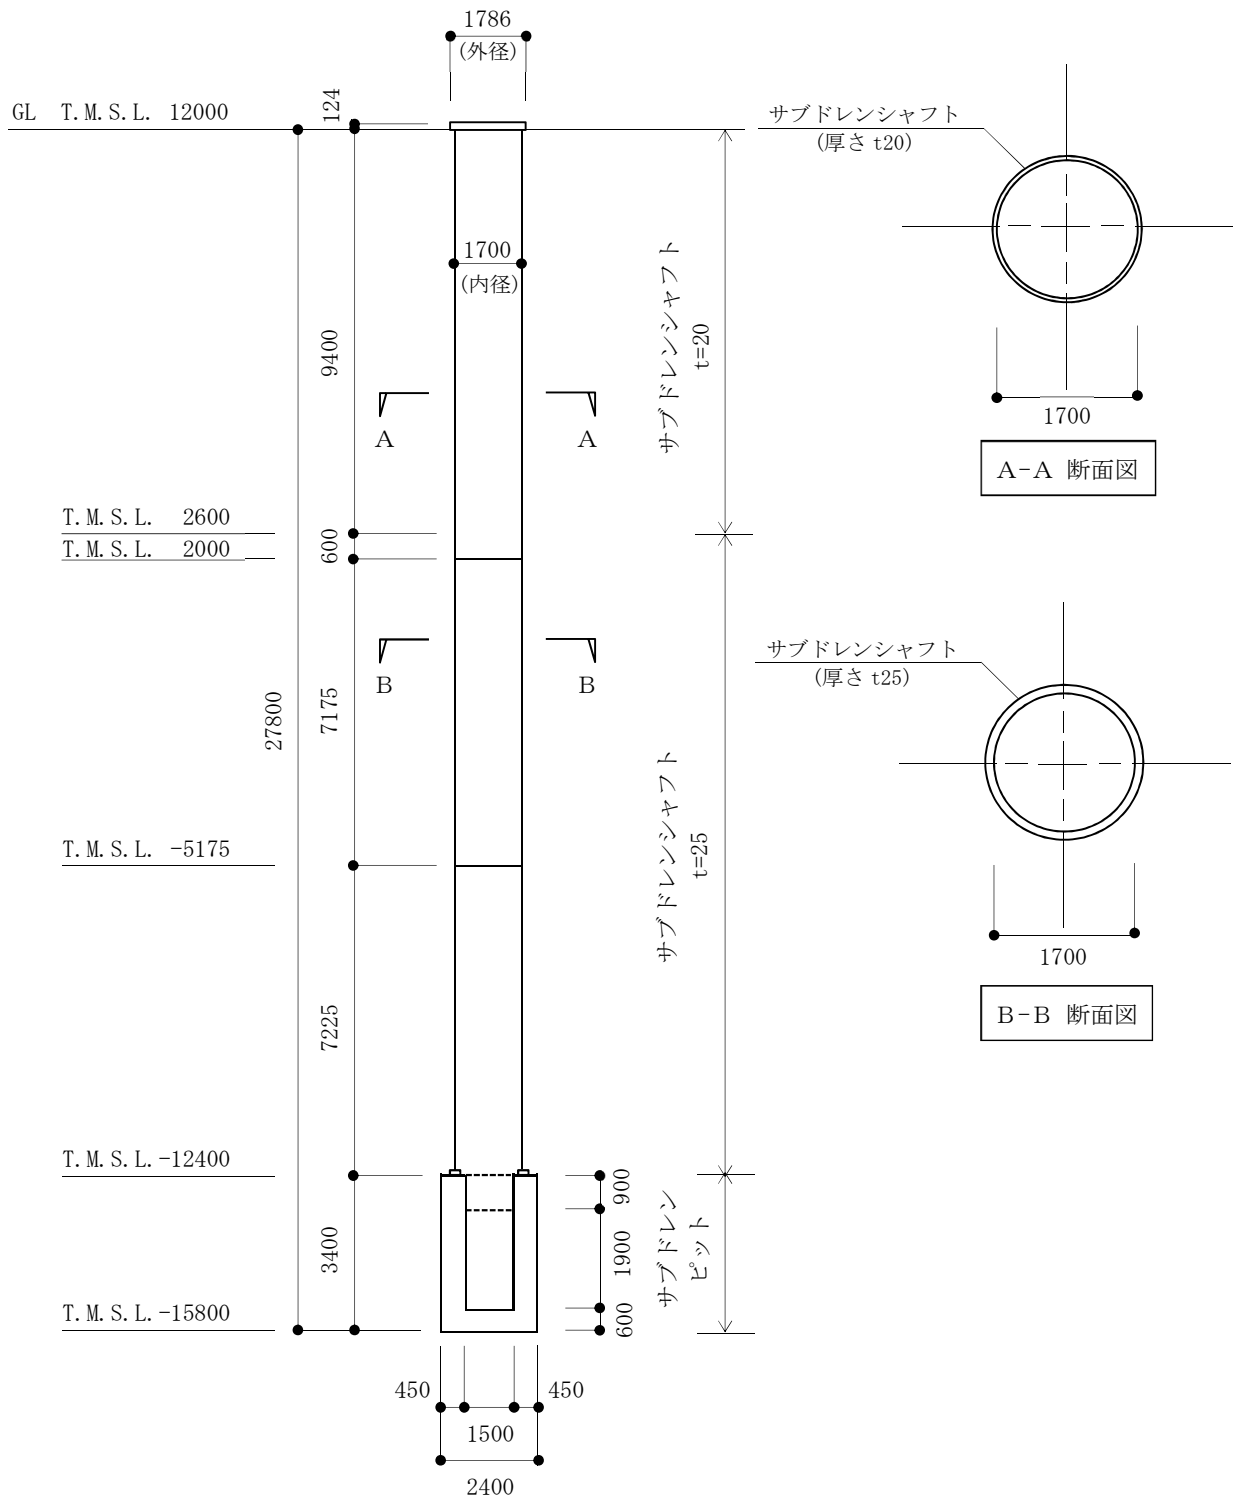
原子炉建屋サブドレンシャフトの概略断面図 (単位 : mm)
